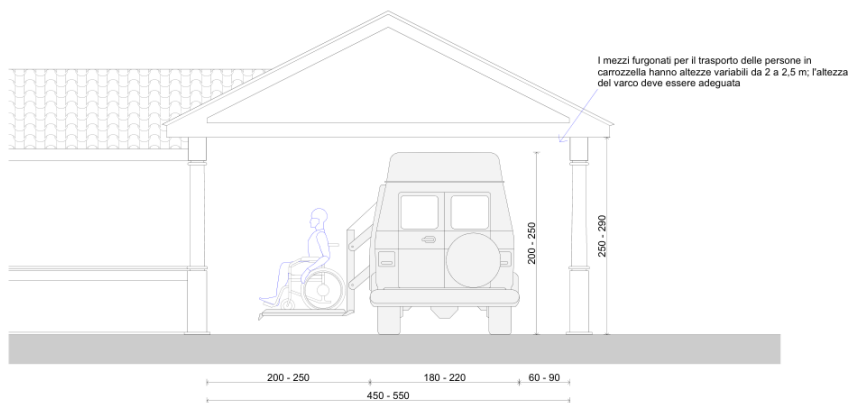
Dimensioni di autorimesse e parcheggi accessibili
